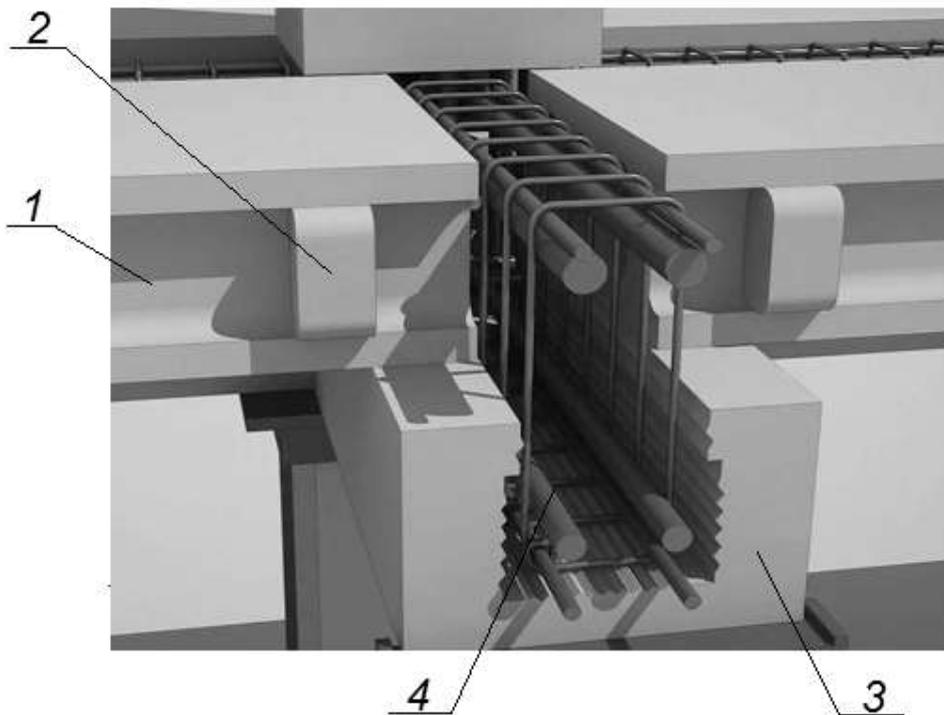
Модель вузла обпирання плити на ригель: 1 – збірна багатопустотна плита; 2 – заглушки з пінополістеролу; 3 – лоткова збірна частина збірно-монолітного ригеля; 4 – монолітна частина ригеля
